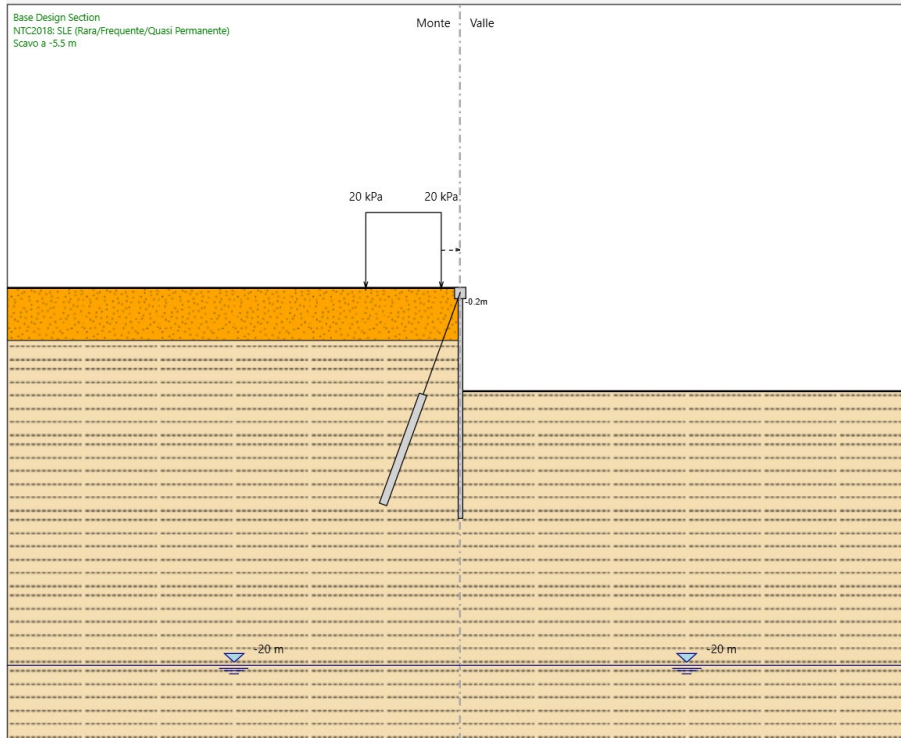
Sezione paratia a cavalletto – Sezione Tipo B1
